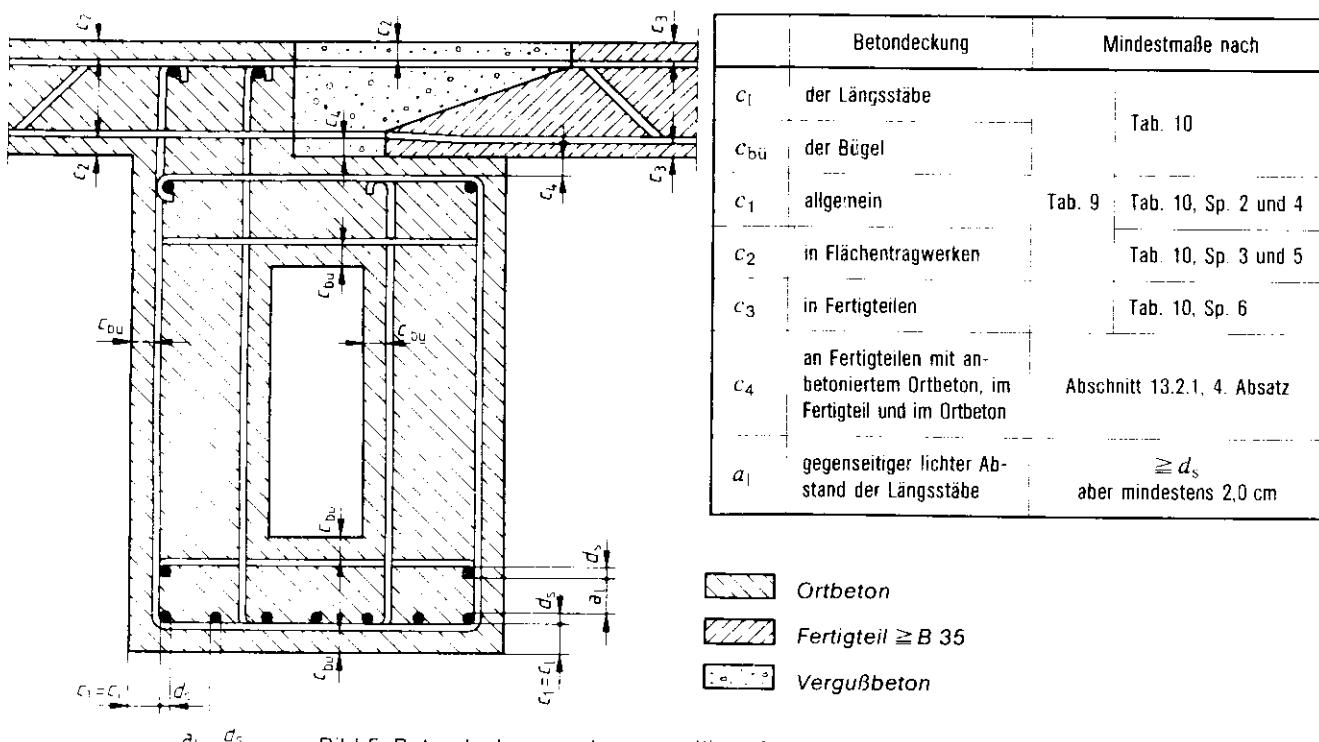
Betondeckung und gegenseitiger Abstand der Bewehrung
